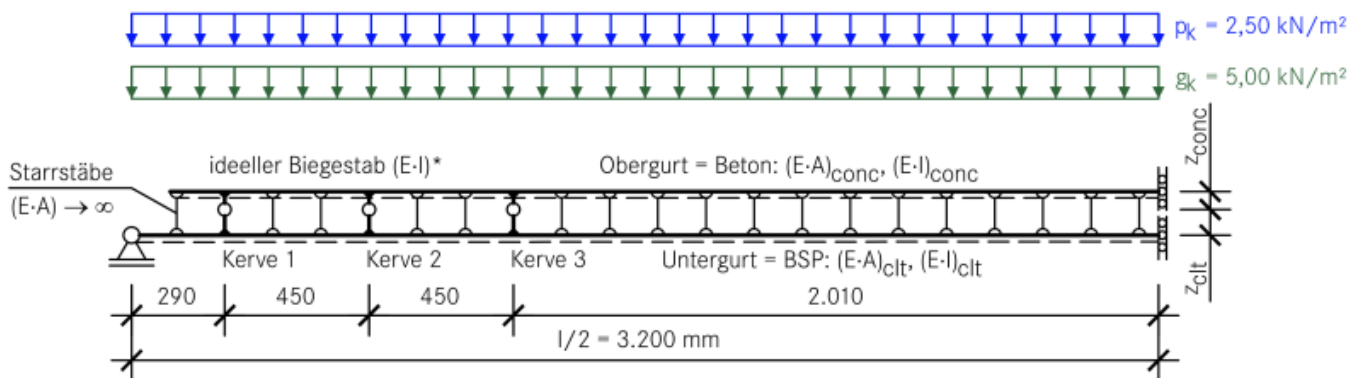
Stabwerkmodell nach Rautenstrauch mit Einwirkung
